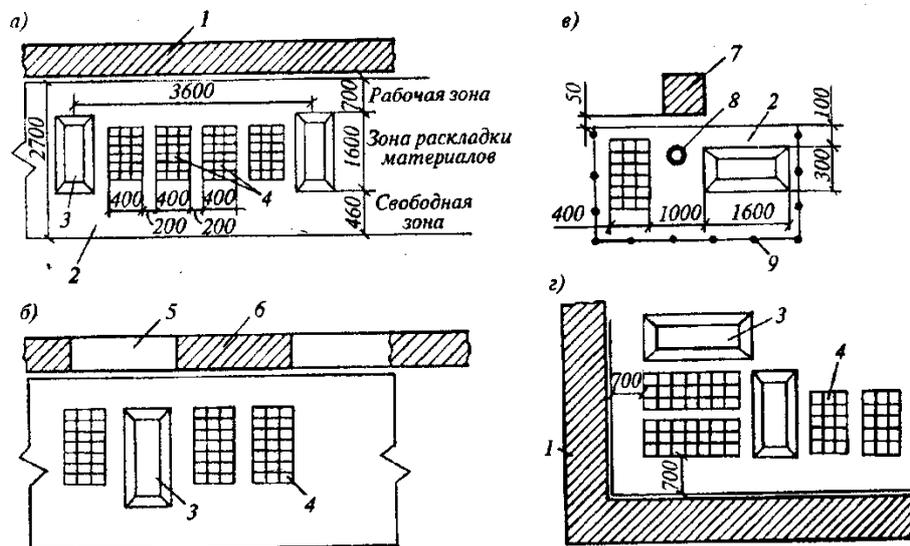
Организация рабочих мест при каменной кладке: а - глухих стен; б - стен с проемами; в — столба; г - угла; 1 - участок возводимой стены; 2 - подмости; 3 - ящик с раствором; 4 - поддон с кирпичом; 5 - проем в стене; 6 - простенок; 7 - возводимый столб; 8 — местоположение каменщика на подмостях; 9 - ограждение подмостей
